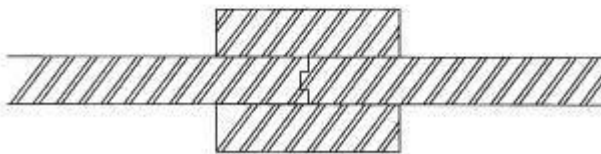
Pilier en blocs de plâtre sur toute la hauteur de la paroi
